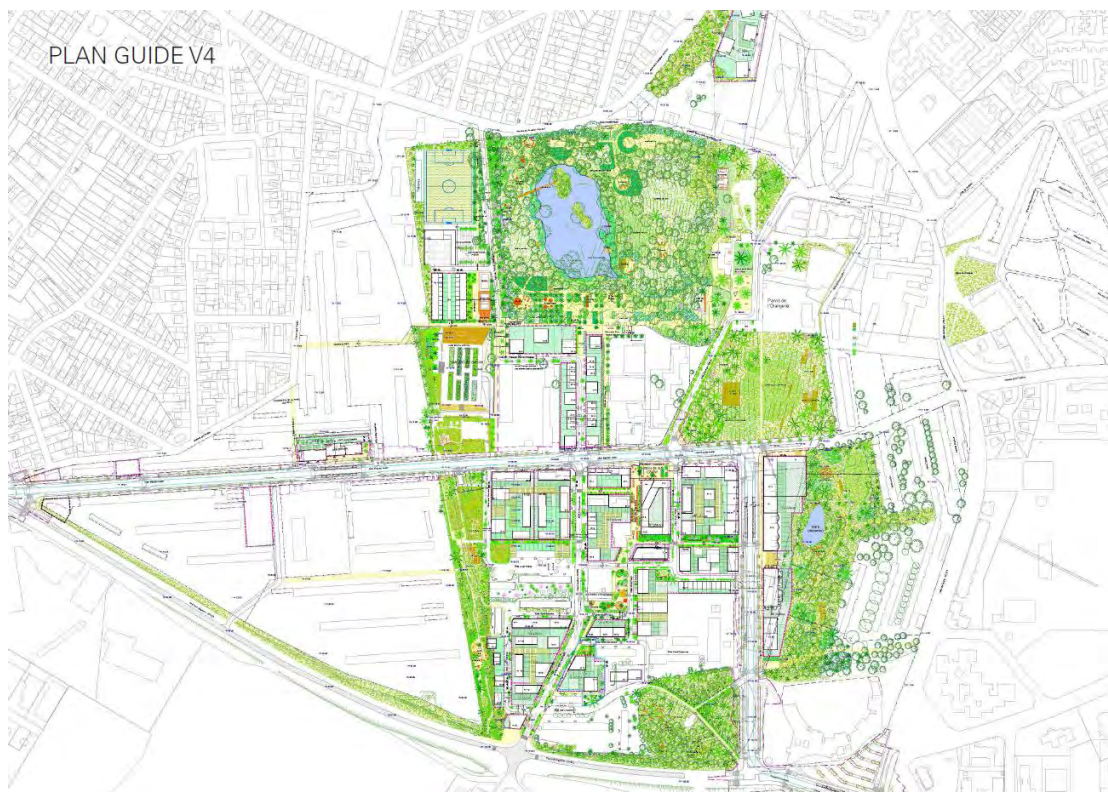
Plan d'aménagement (Source : BASE, avril 2017)
